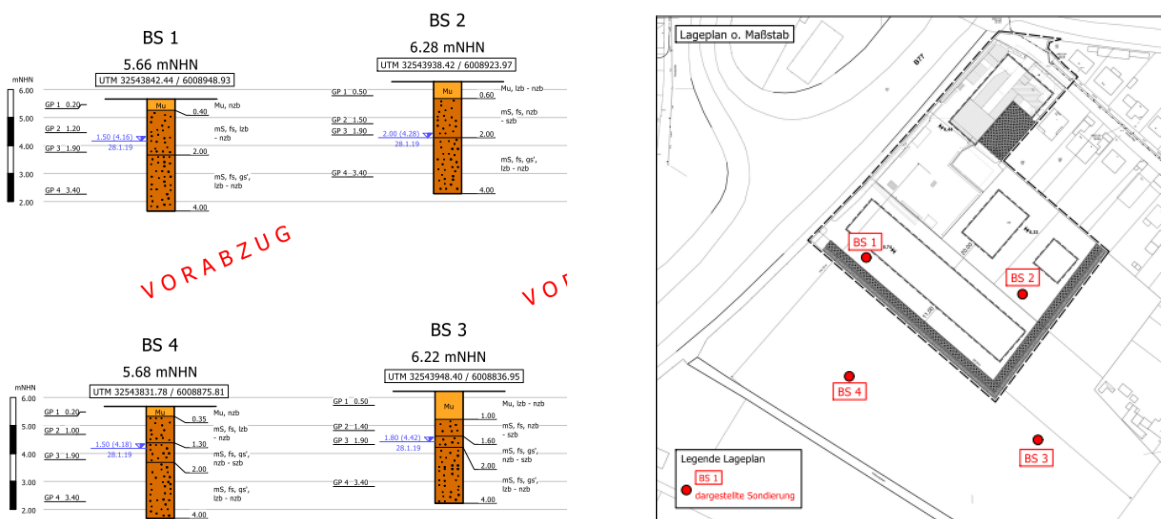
+ 7: Ergebnisse und Lage Bohrsondierungen – Stand Feb. 2019 – GSB Grundbau
